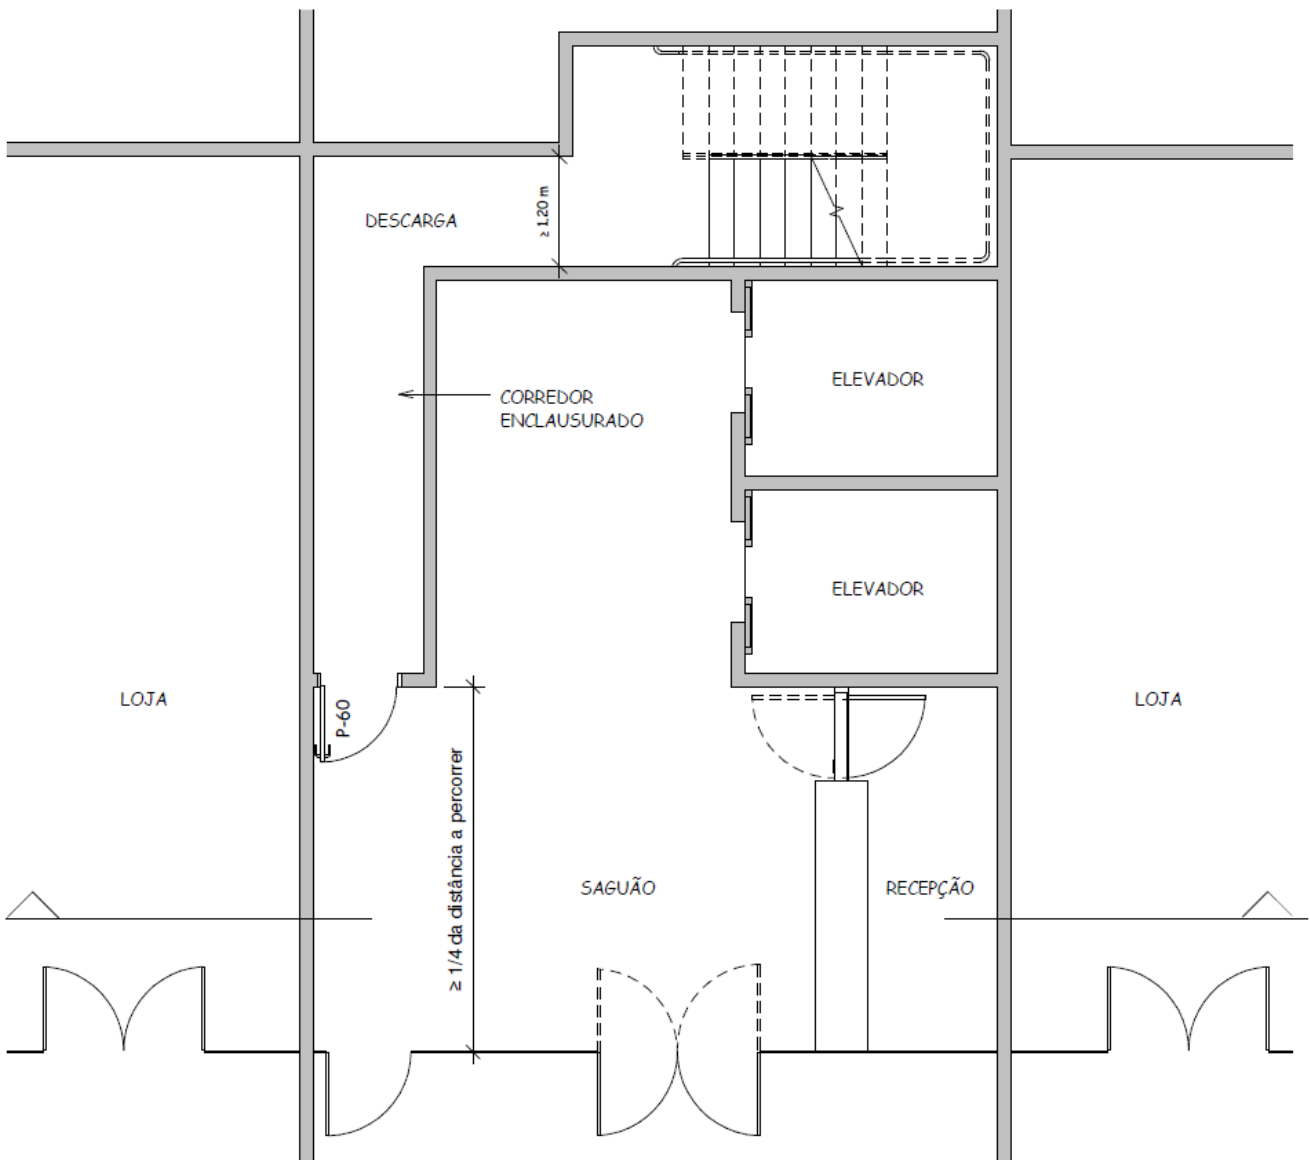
D - Descarga com corredor enclausurado (planta baixa).
